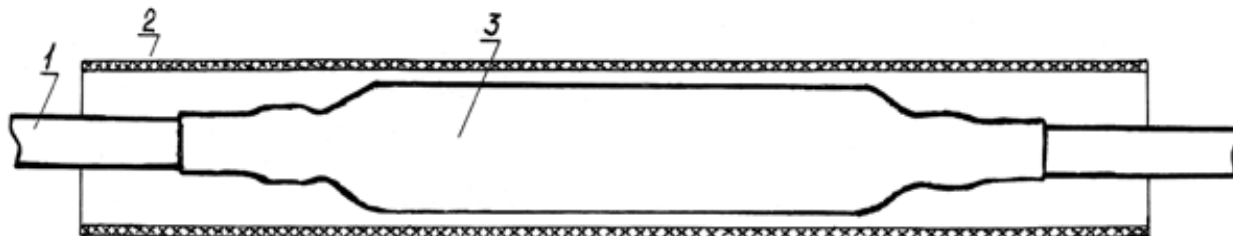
Усадка наружной трубки ТУТ. Наружная трубка ТУТ должна перекрывать внутреннюю с каждой стороны муфты не менее чем на 70 мм: 1 – кабель с покровом типа «Шп»; 2 – наружная трубка ТУТ; 3 – усаженная внутренняя трубка ТУТ.
